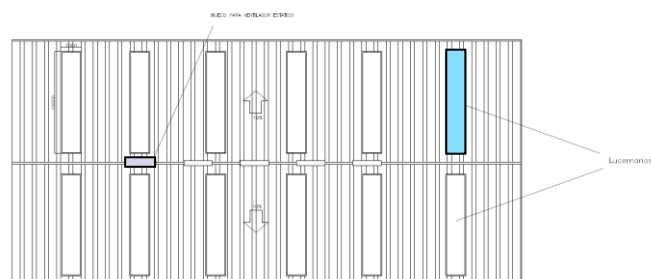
Cubierta del edificio industrial, detalle plano 8.3
